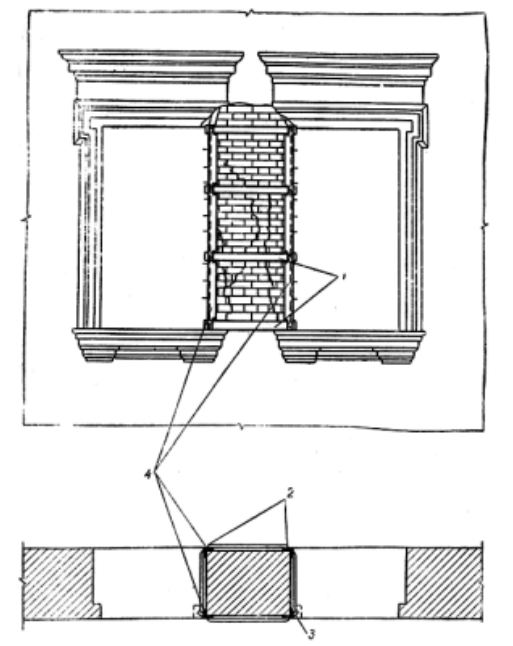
Усиление кирпичного простенка устройством металлического каркаса: 1 - накладка из полосовой стали; 2 - оштукатуривание теплым раствором по тканной сетке; 3 - приварка штырей для бетонирования четвертей; 4 - стойки из стальных уголков
